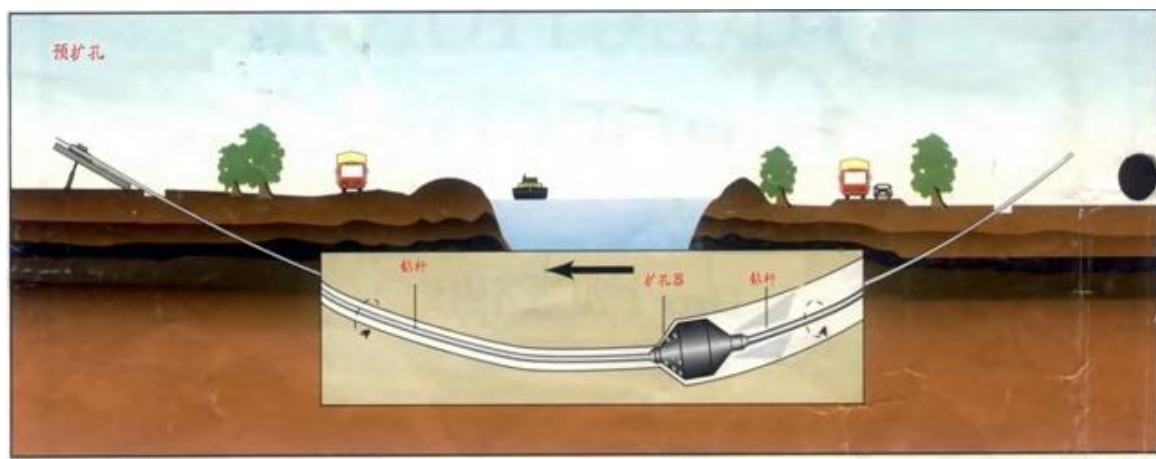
定向钻穿越施工预扩孔过程断面示意图
